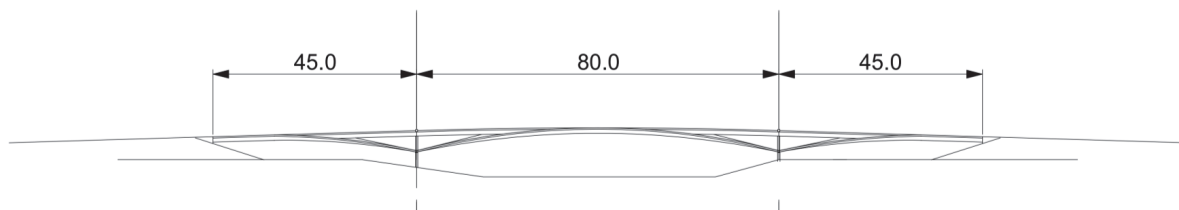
Soluzione a travata continua con sezione a cassone ed anime alleggerite
